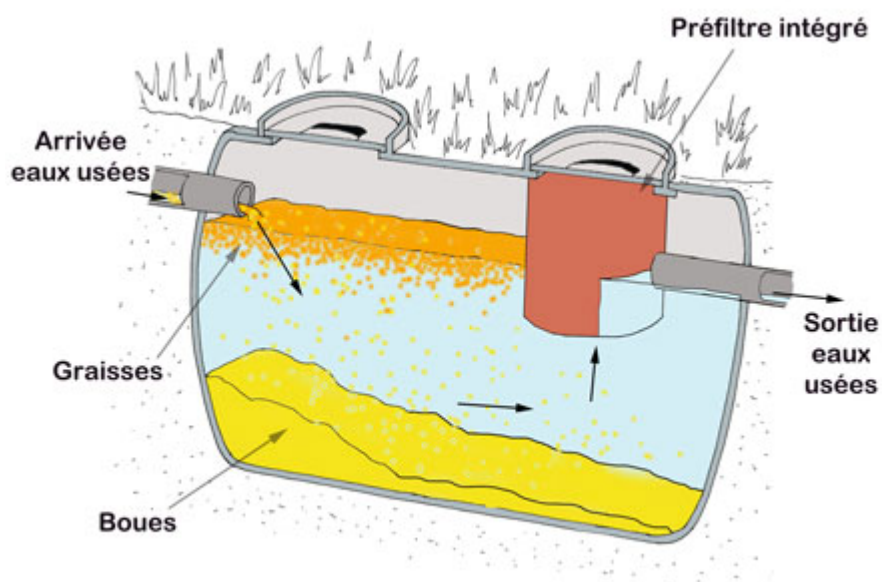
Schéma d'une fosse toutes eaux. Source : ccdraga.fr
